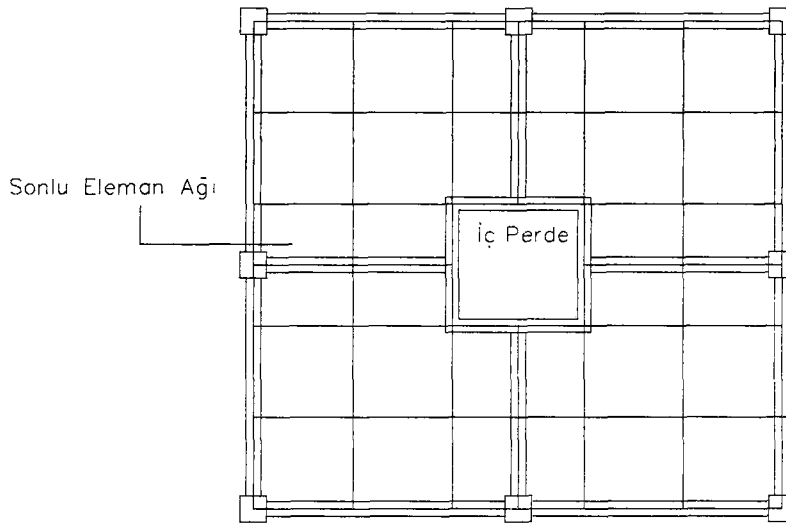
Grup 2.1 Tipik Bodrum Kat Kalıp Planı
